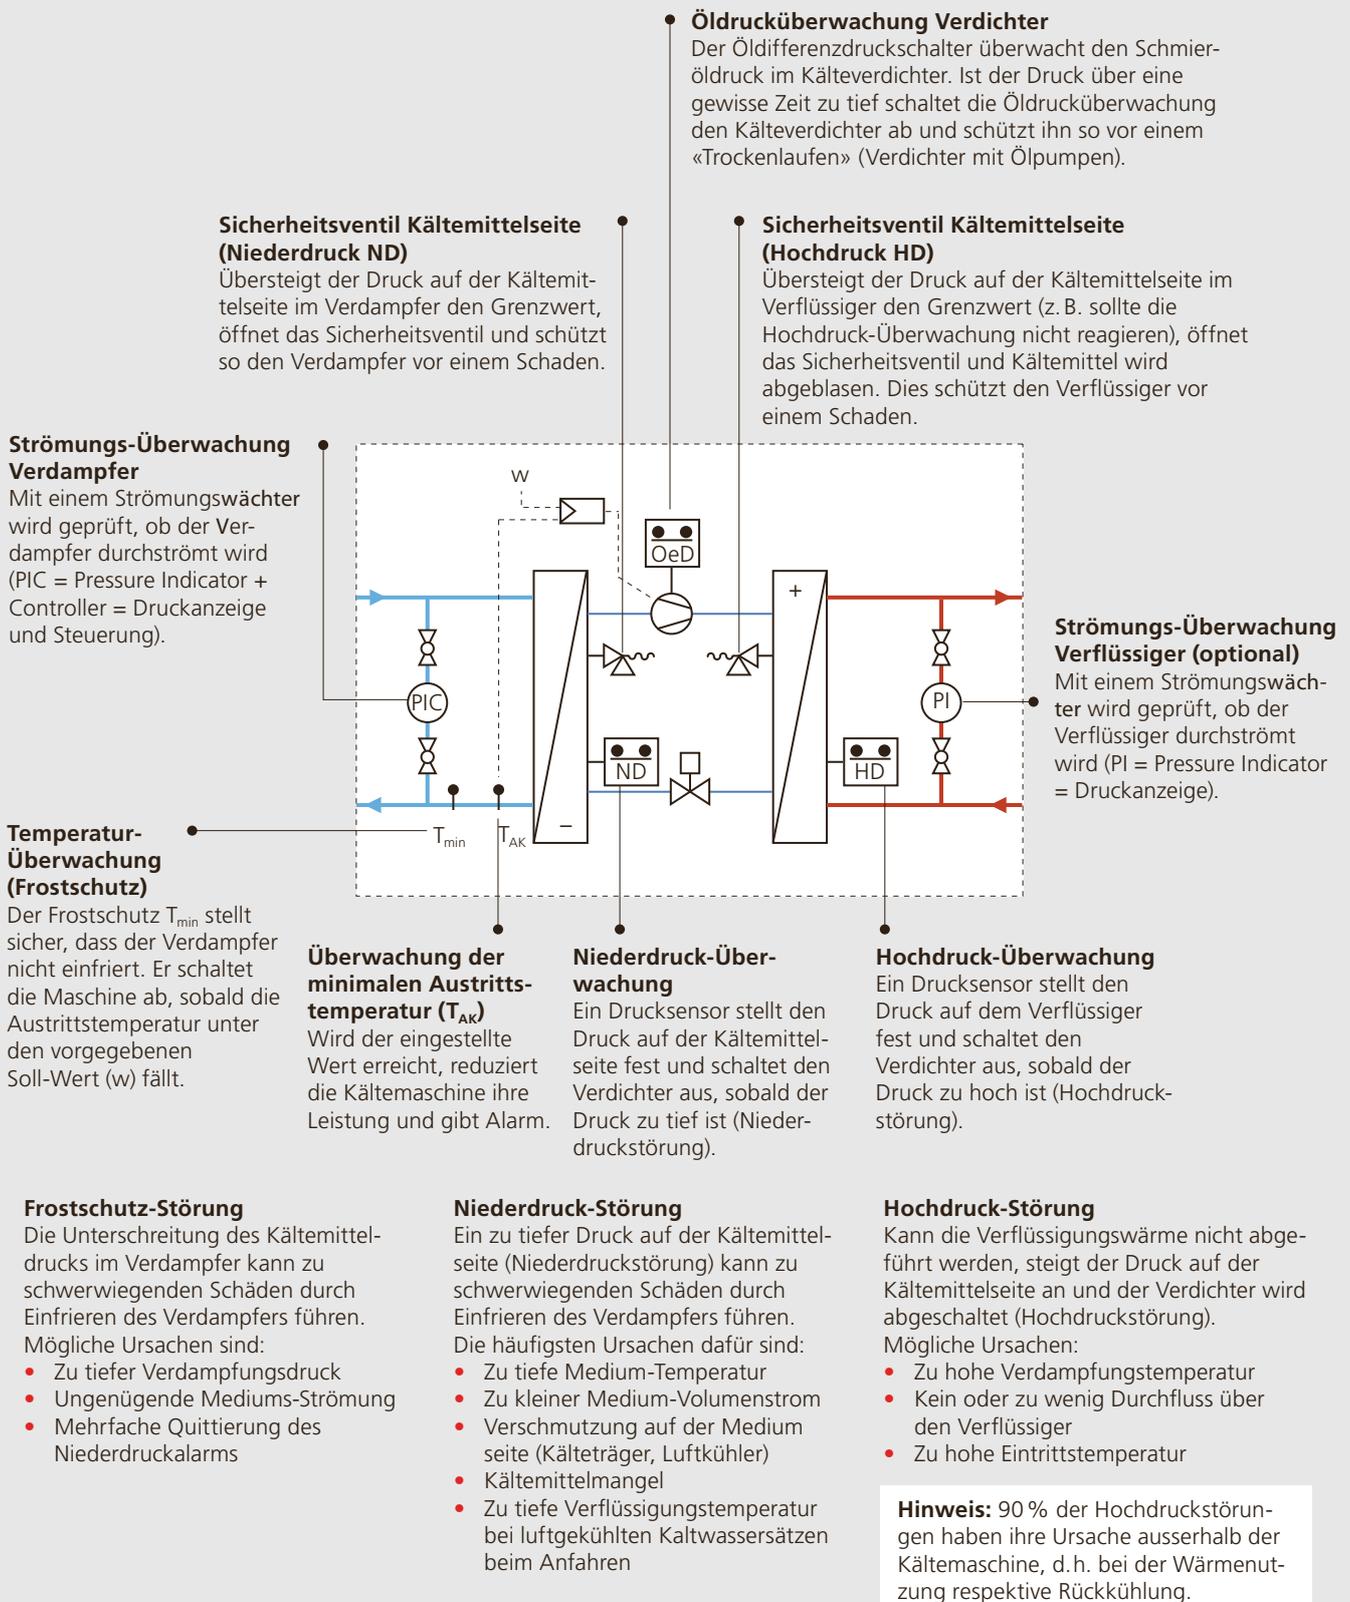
Sicherheitsrelevante Regel- und Steuergrößen bei Kältemaschinen.
